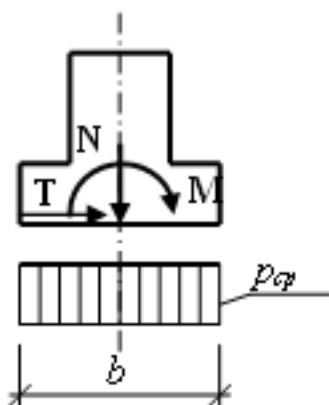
Схема до перевірки напруження під подошвою центрально навантаженого фундаменту
